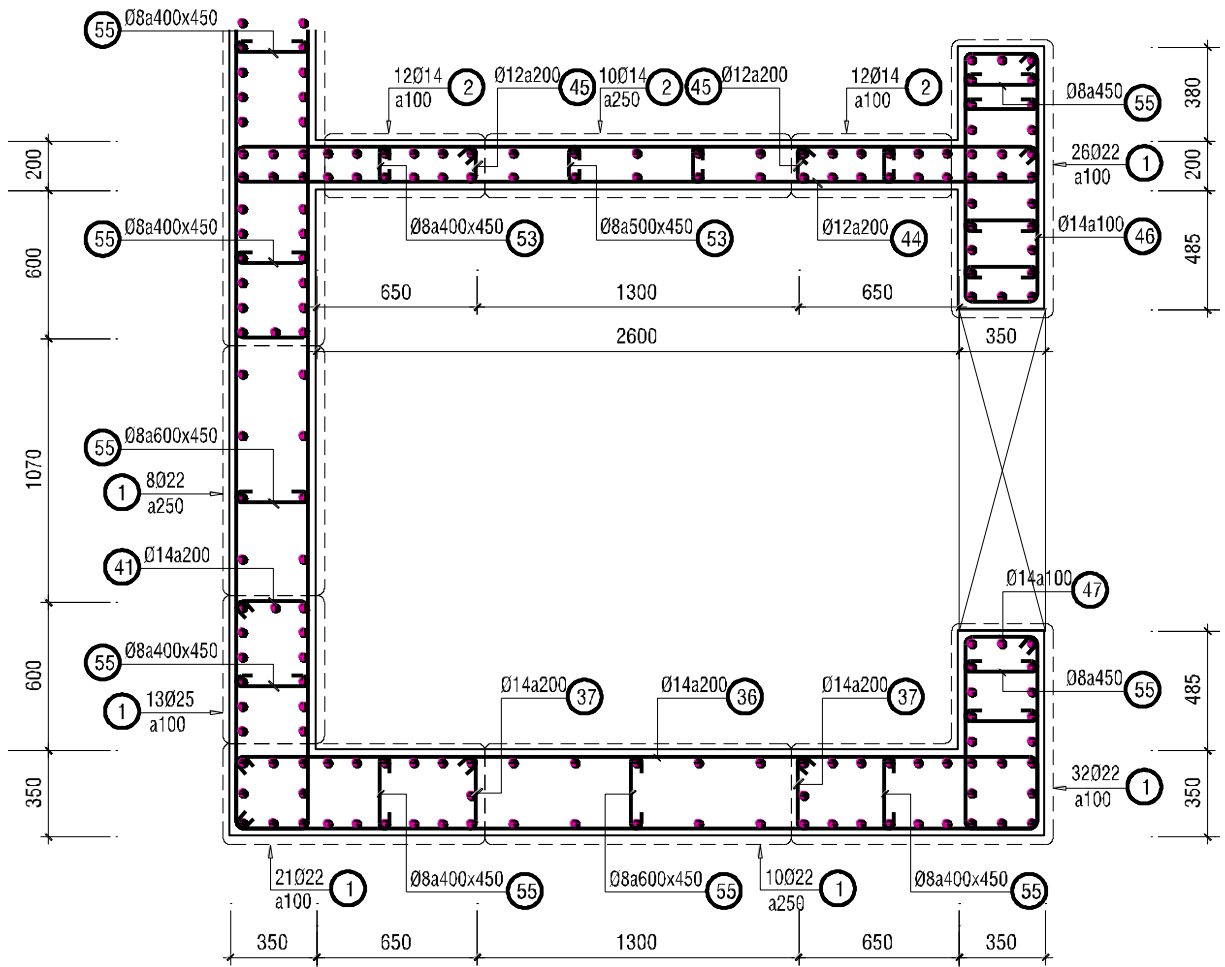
41. Cấu tạo cốt thép gia cường lanh tô cửa.
